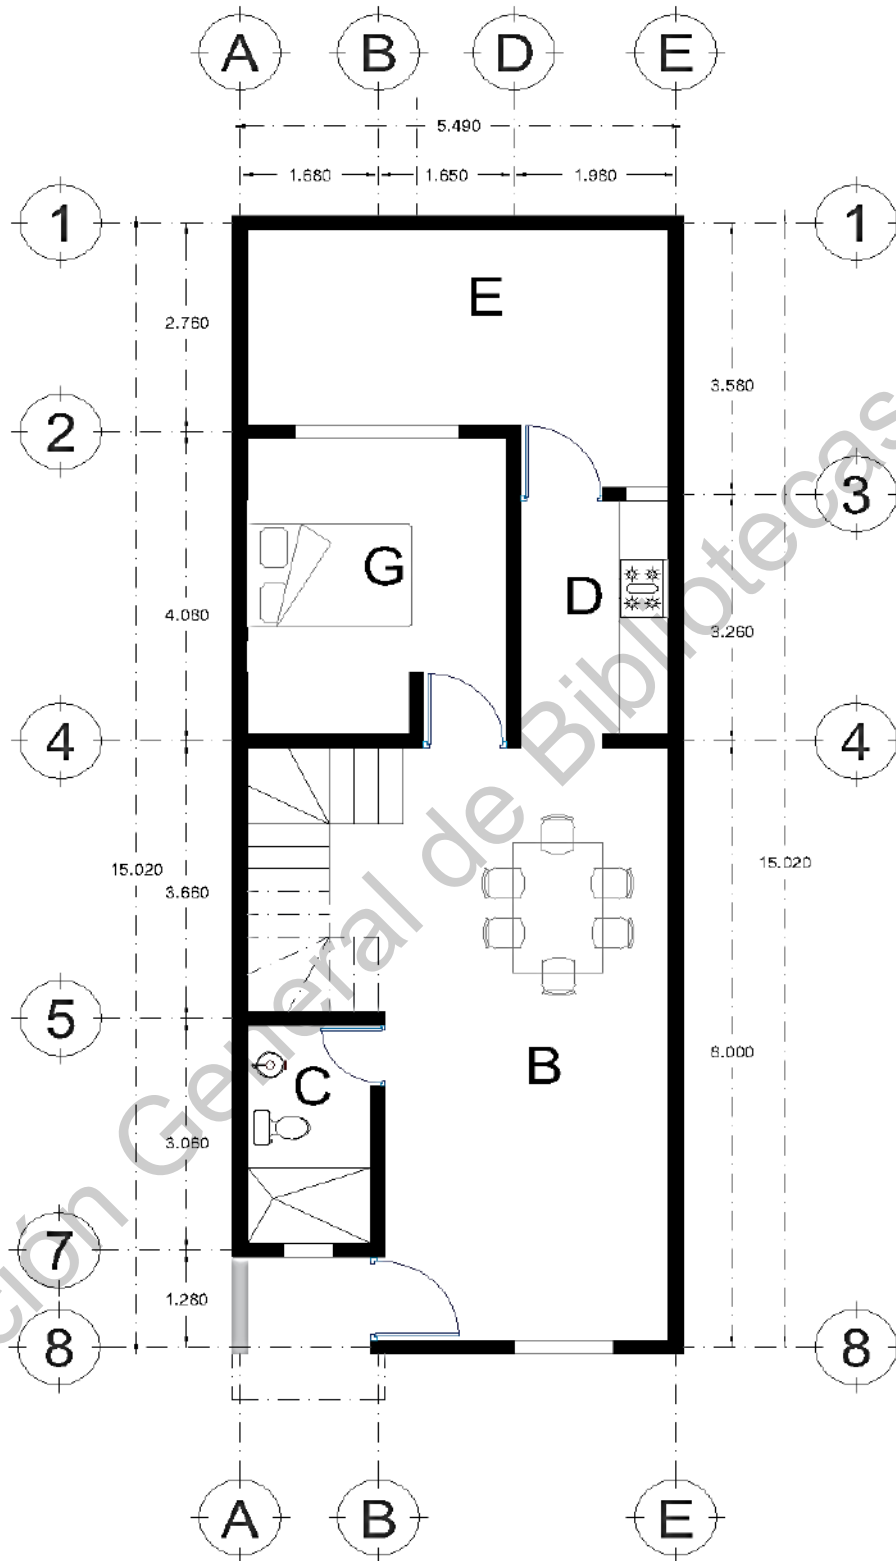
Planta Arquitectónica Baja. Casa Viñedos.
